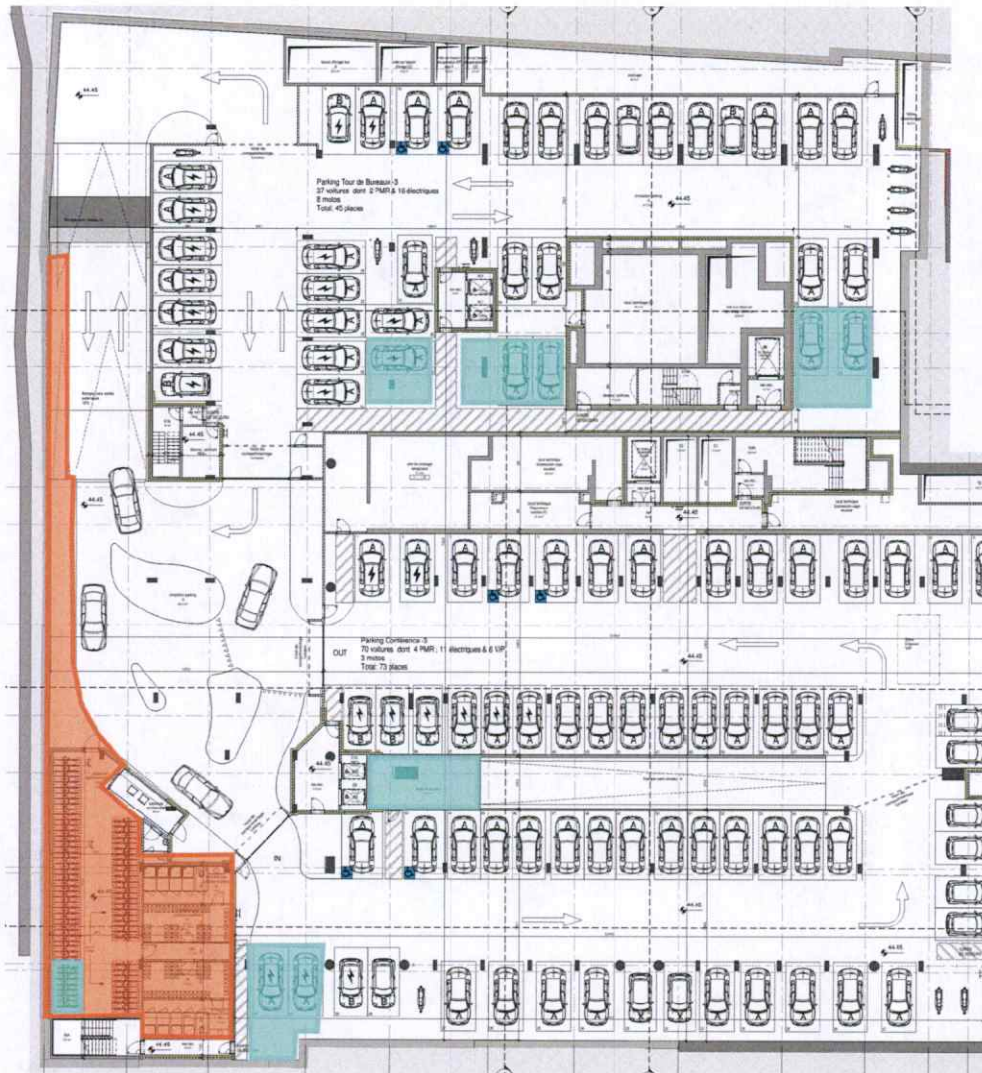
parkings vélos intérieurs pour le Centre de Conférences CC (niveau -3)- Projet amendé
